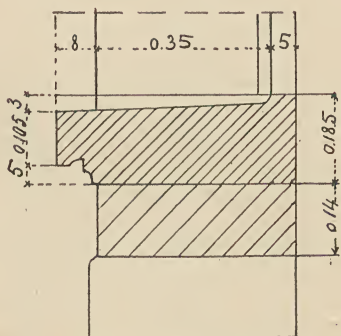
Coupe de l'appui du rez-de-chaussée.
